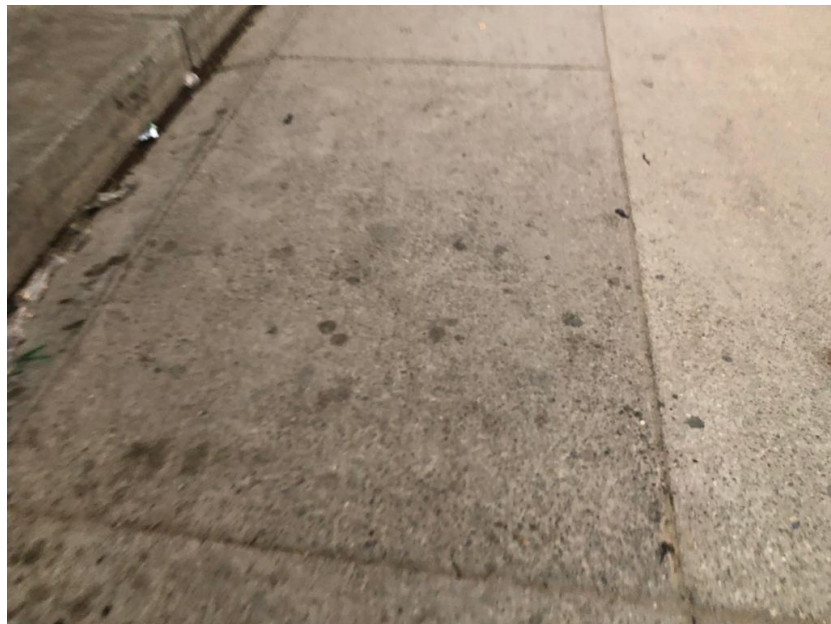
Tramo 14 UM – 42 Popouts con grietas lineales
